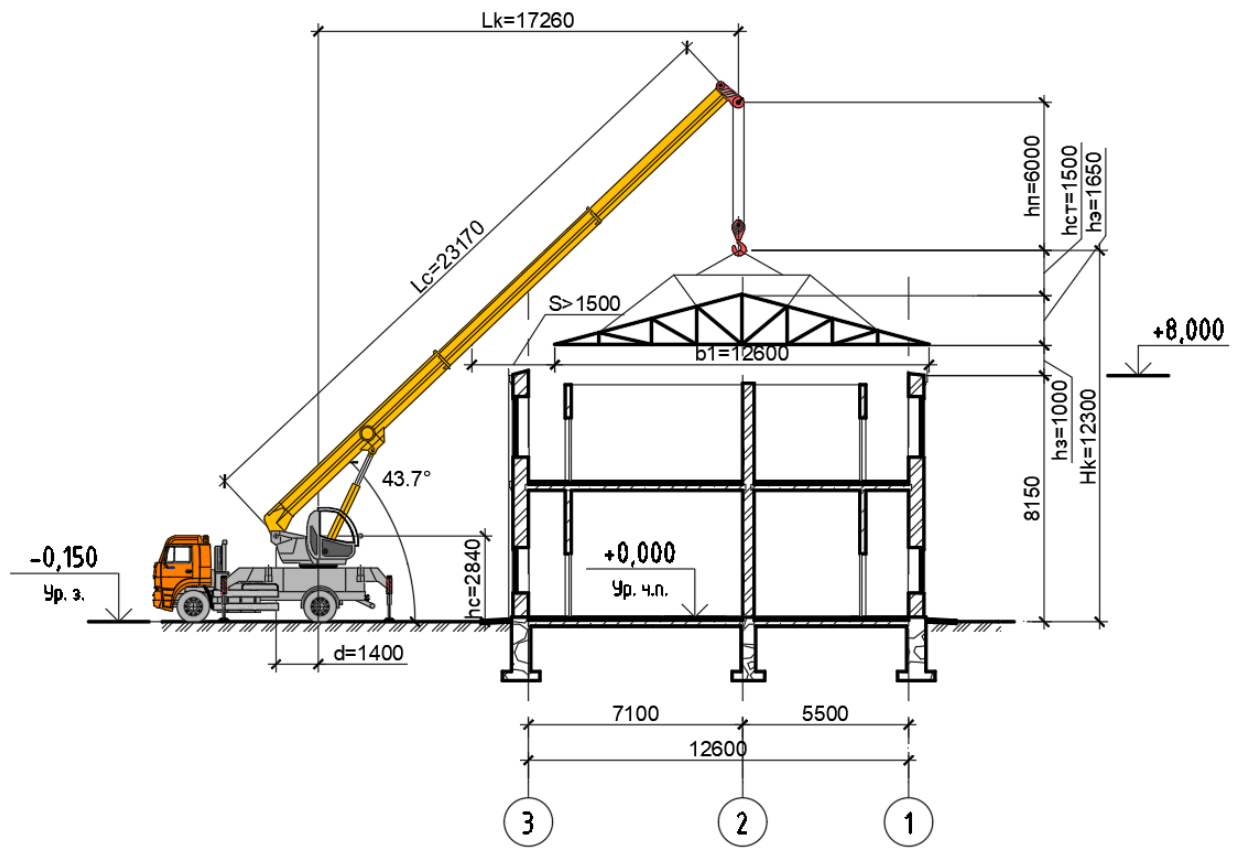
Схема монтажа фермы покрытия автокраном
